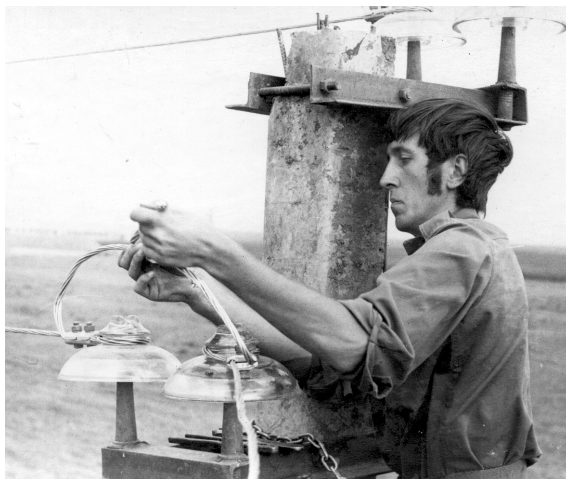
Крепление проводов к изоляторам на анкерной опоре
